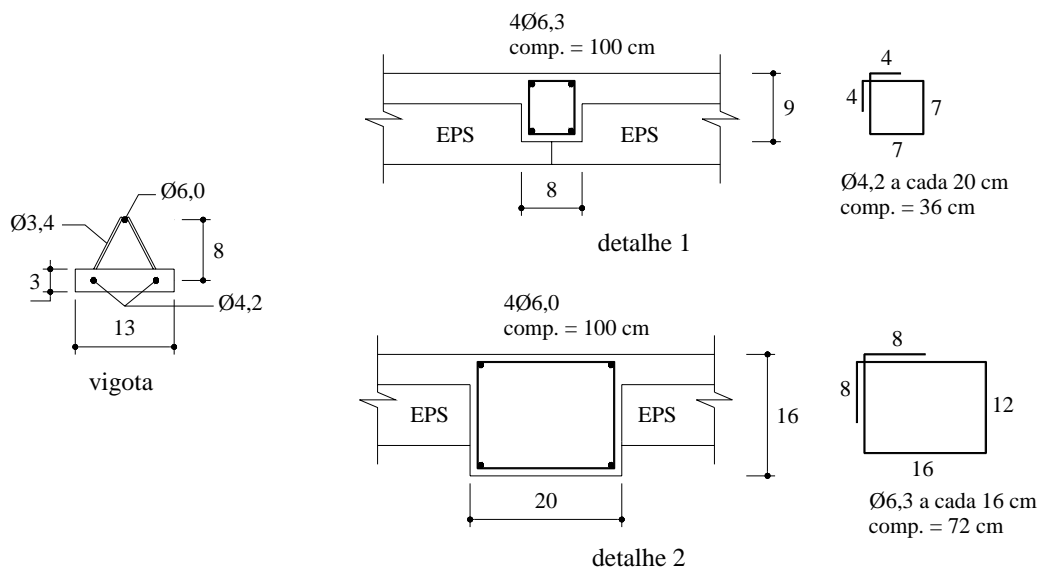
Detalhes da vigota, nervura transversal e viga de apoio (dimensões em cm)
